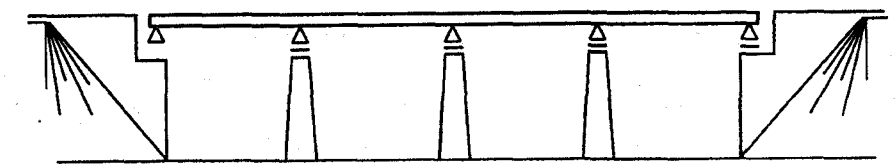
Przekrój poprzeczny mostu żelbetowego [7]
